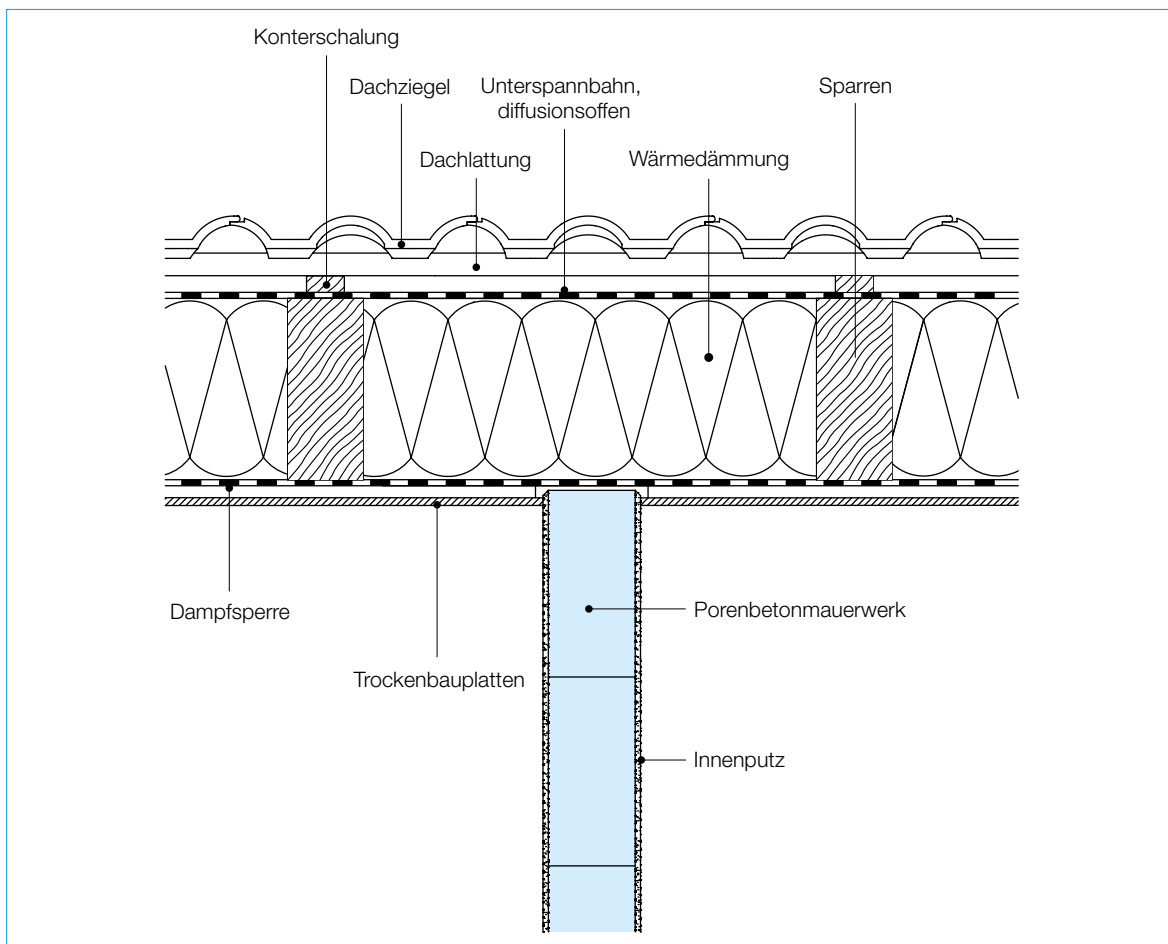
Oberer Anschluss einer nicht tragenden Innenwand aus Porenbetonmauerwerk an ein Holzdach
